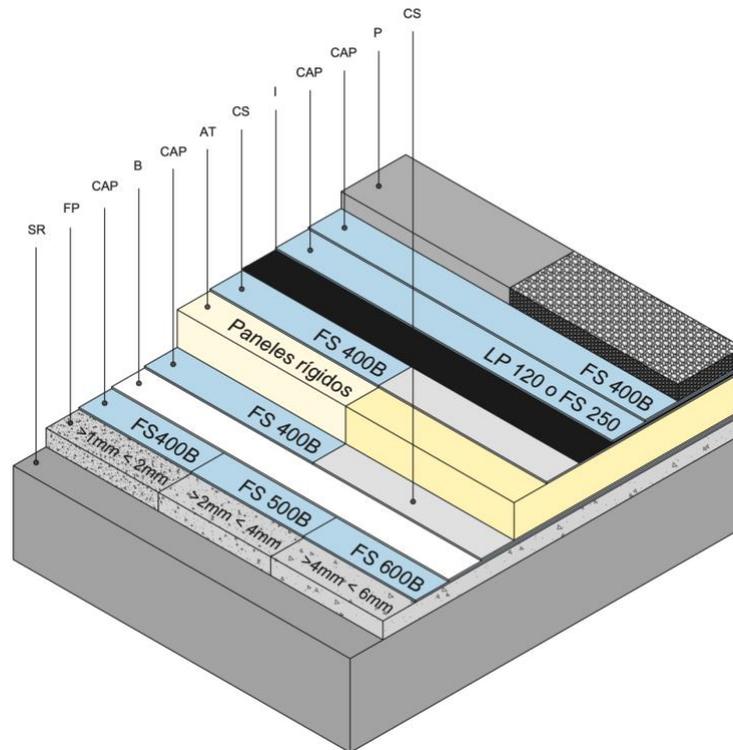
Posición capa antipunzonante en cubierta convencional (C). Leyenda: SR Soporte resistente. FP Formación de pendiente. CAP Capa antipunzonante. B Barrera corta vapor. AT Aislante térmico. CS Capa separadora. I Impermeabilización. P Protección (hormigón in situ o gravilla).
